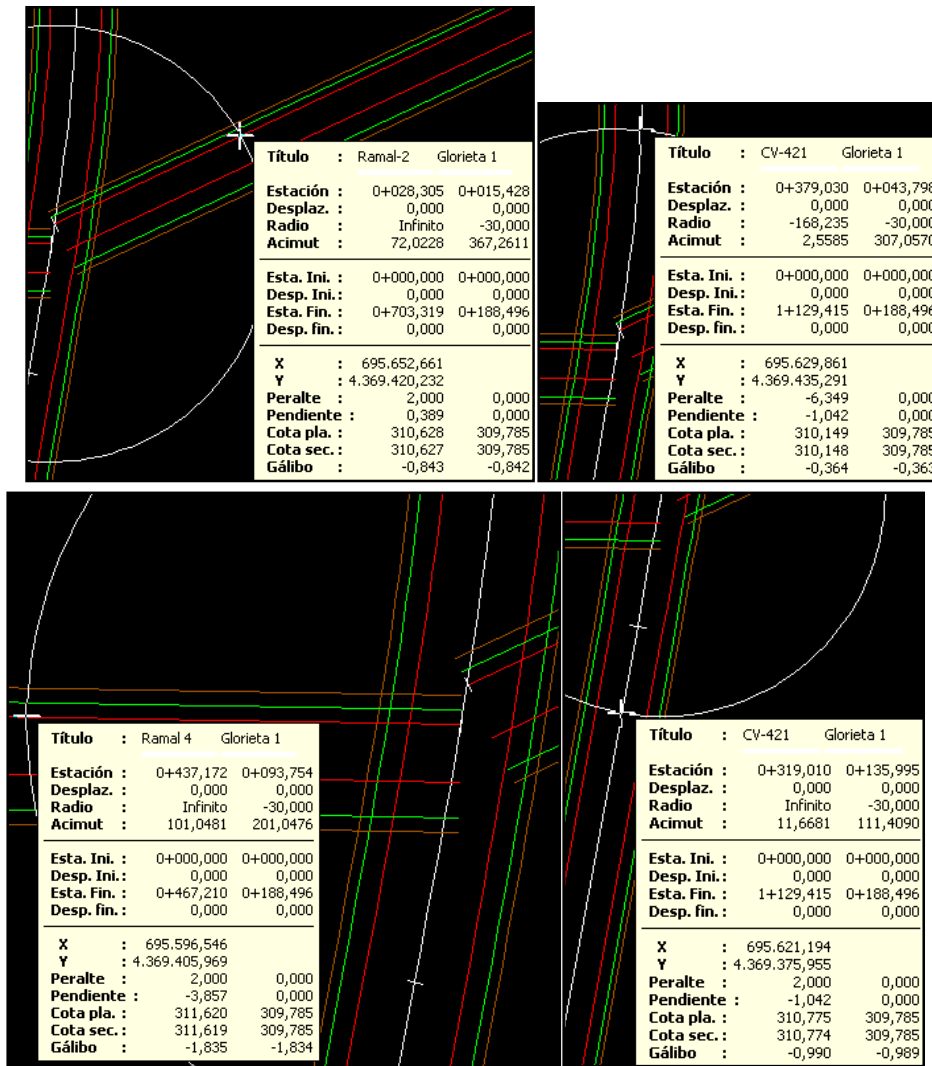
Intersecciones de ejes en planta para generar las marcas de rasante.
